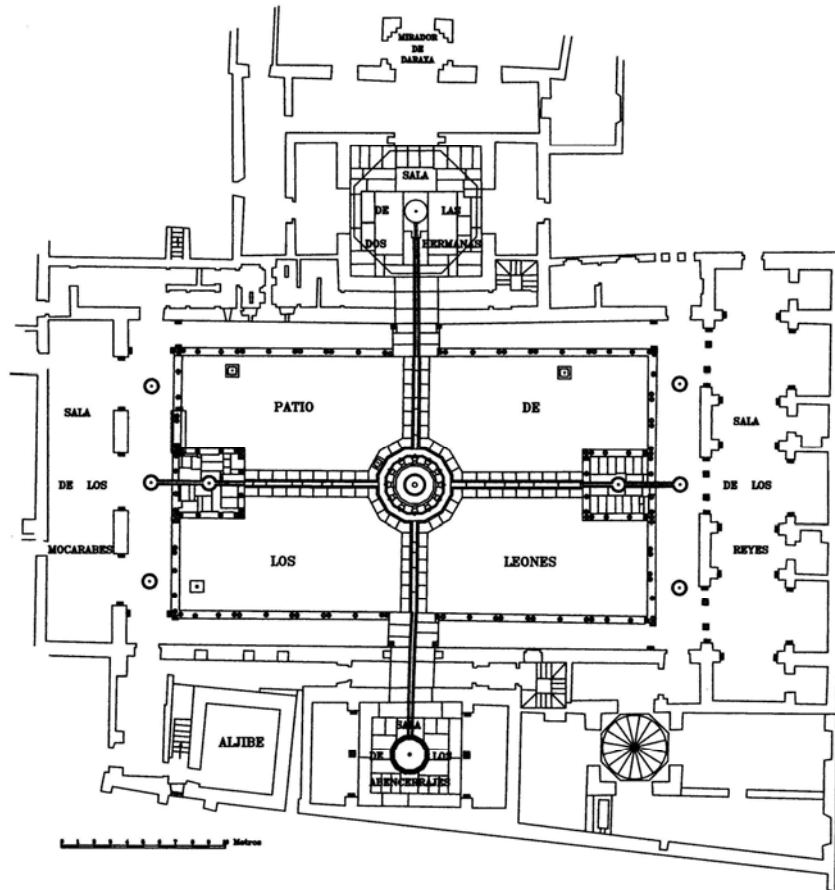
Plano de planta del Palacio de los Leones, donde se muestra la composición estructural básica. Adaptado del Plano n° nuevo 158 de la Sección de Mapas, Planos y Dibujos del Archivo Central del Patronato de la Alhambra.
